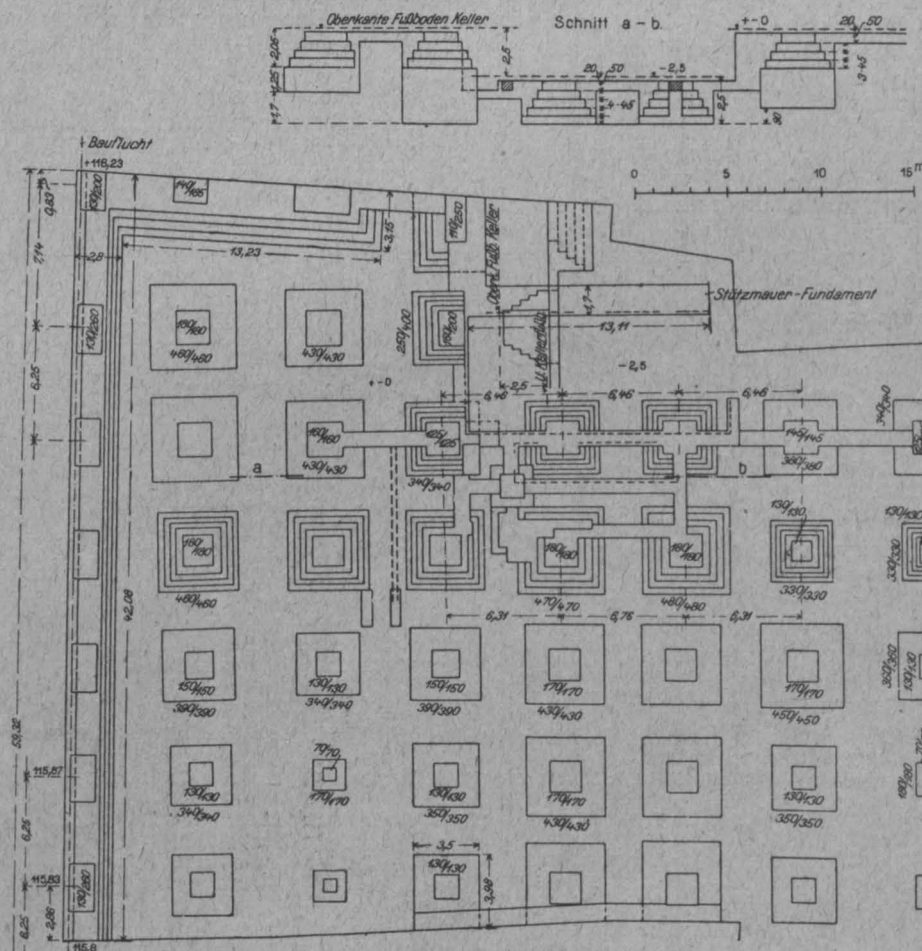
Teilgrundriß der Fundamente mit Schnitt durch das durchgehende Bankett der Hinterfront-Stützen im Heizkeller.
